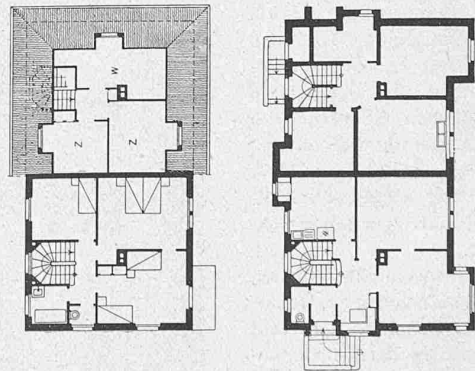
Grundrisse zum Haus C. — 1:400.
